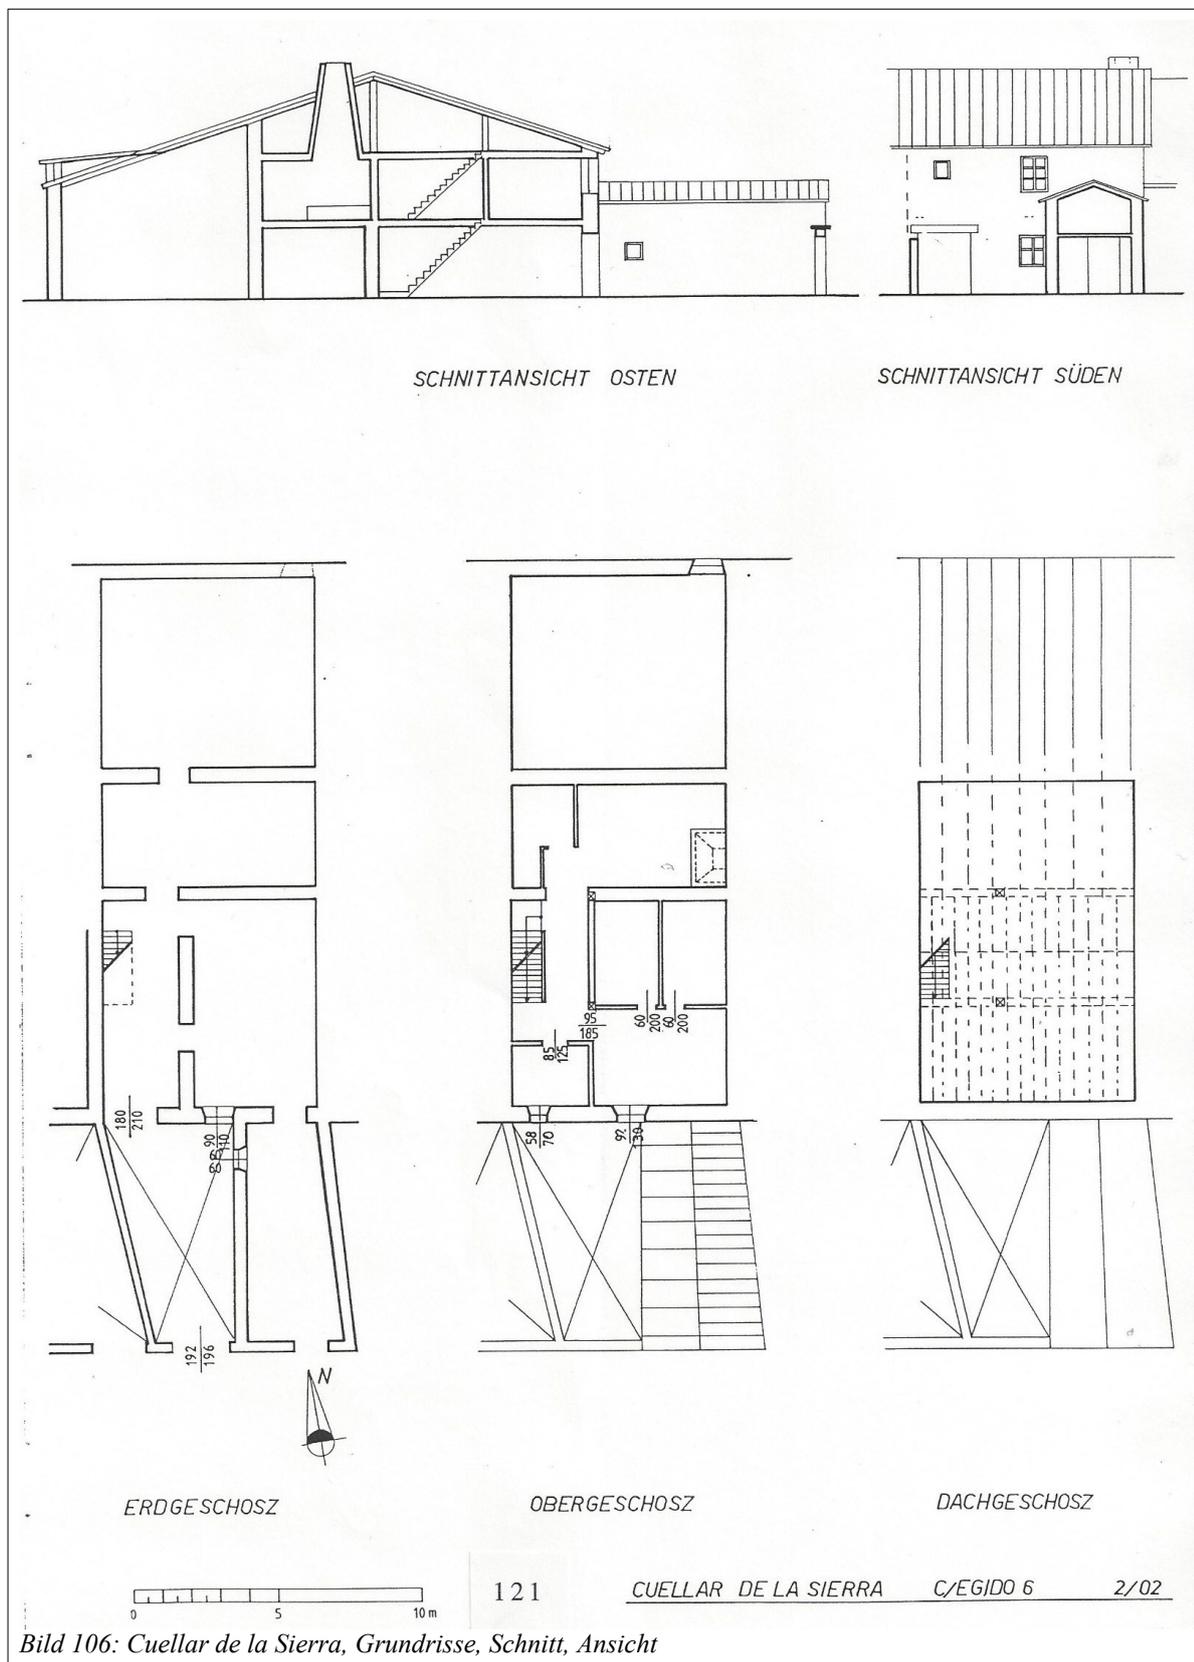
Cuellar de la Sierra, Grundrisse, Schnitt, Ansicht
